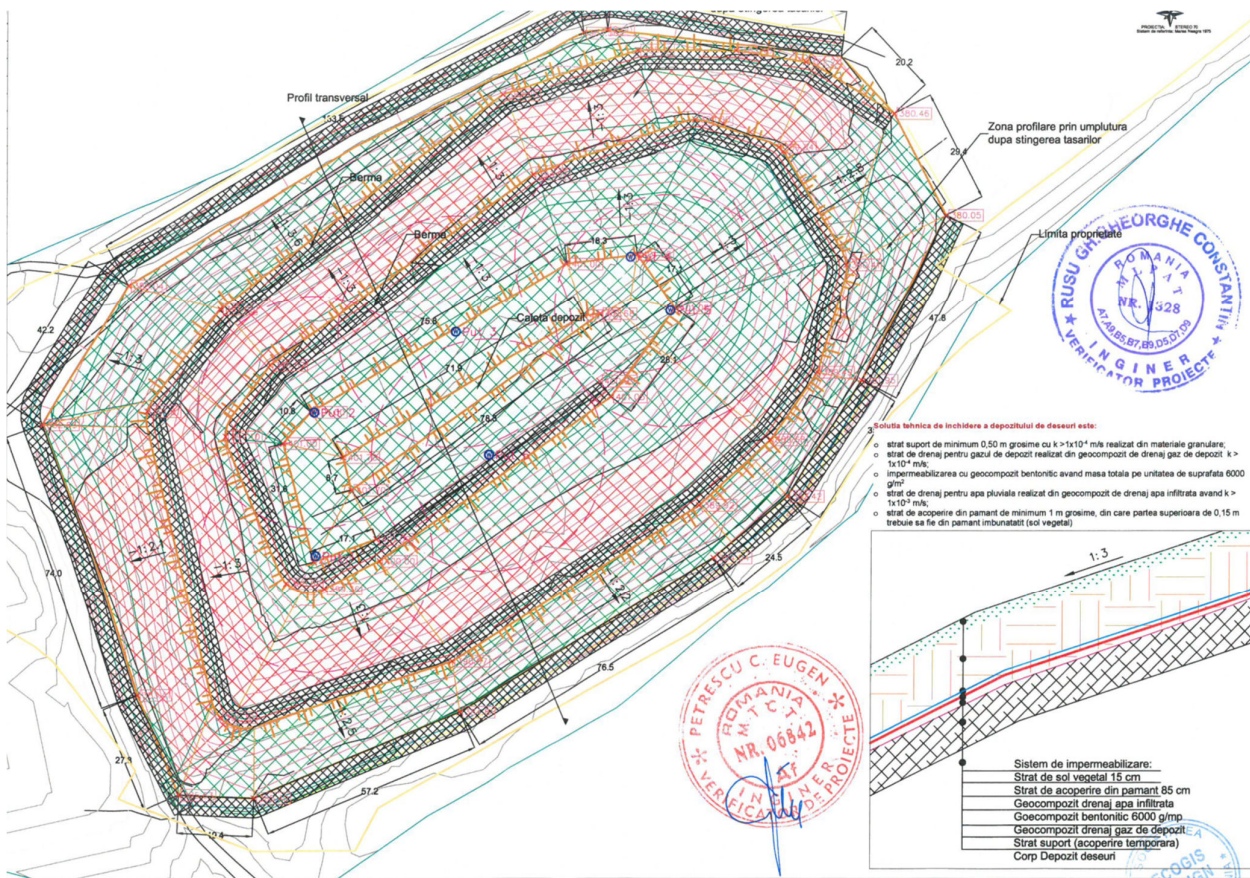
Plan profilare corp depozit. Legenda: Rosu sapatura, Verde Umplutura
